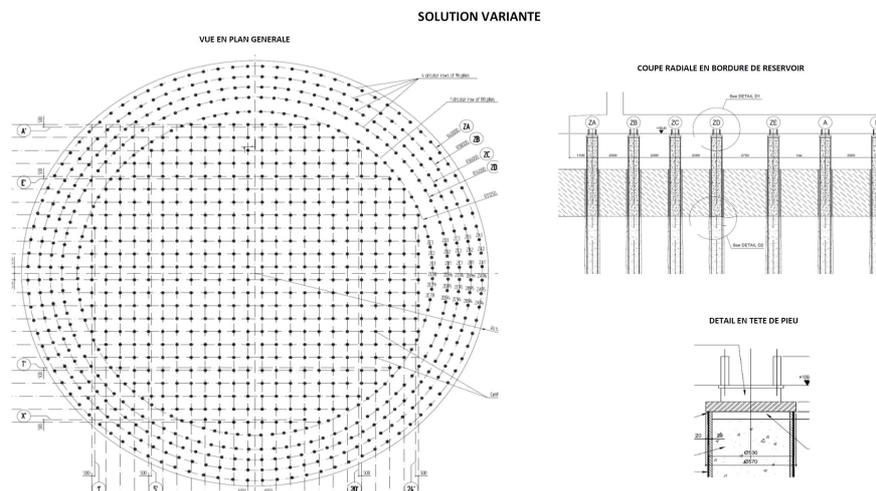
principe des fondations de la variante du groupement d'Entreprises
